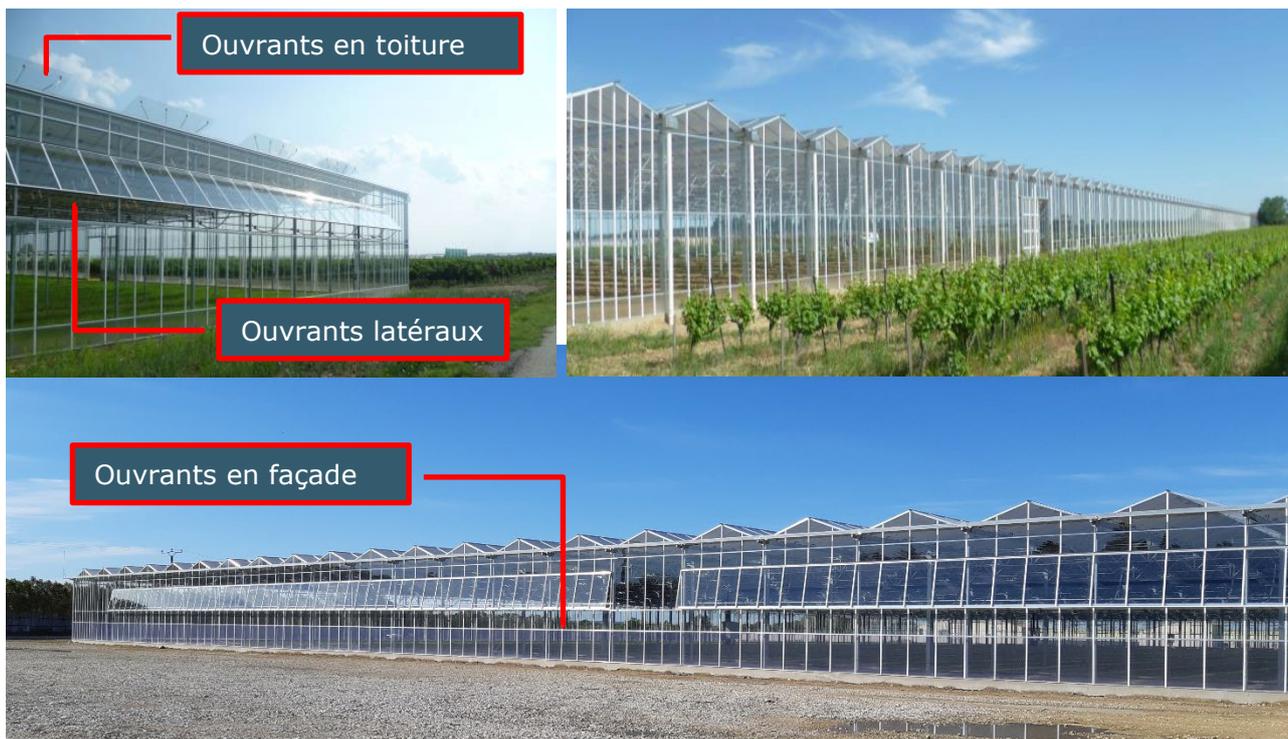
Ouvrants en façade et en toiture. Source : Reden Solar.
